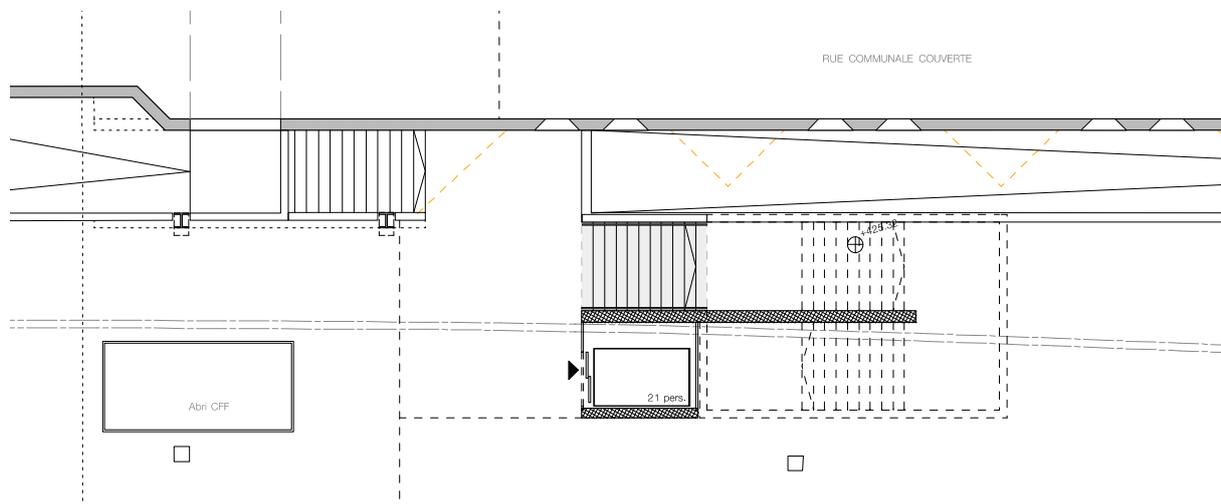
Liaison centrale verticale _ vue en plan niveau quai _ échelle : 1/200
